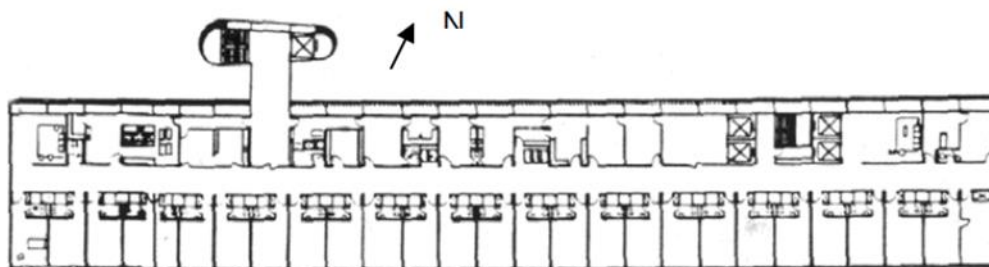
Pavimento tipo da Lâmina vertical do Hospital Sul-América. Fonte: Cavalcanti, 2001.
